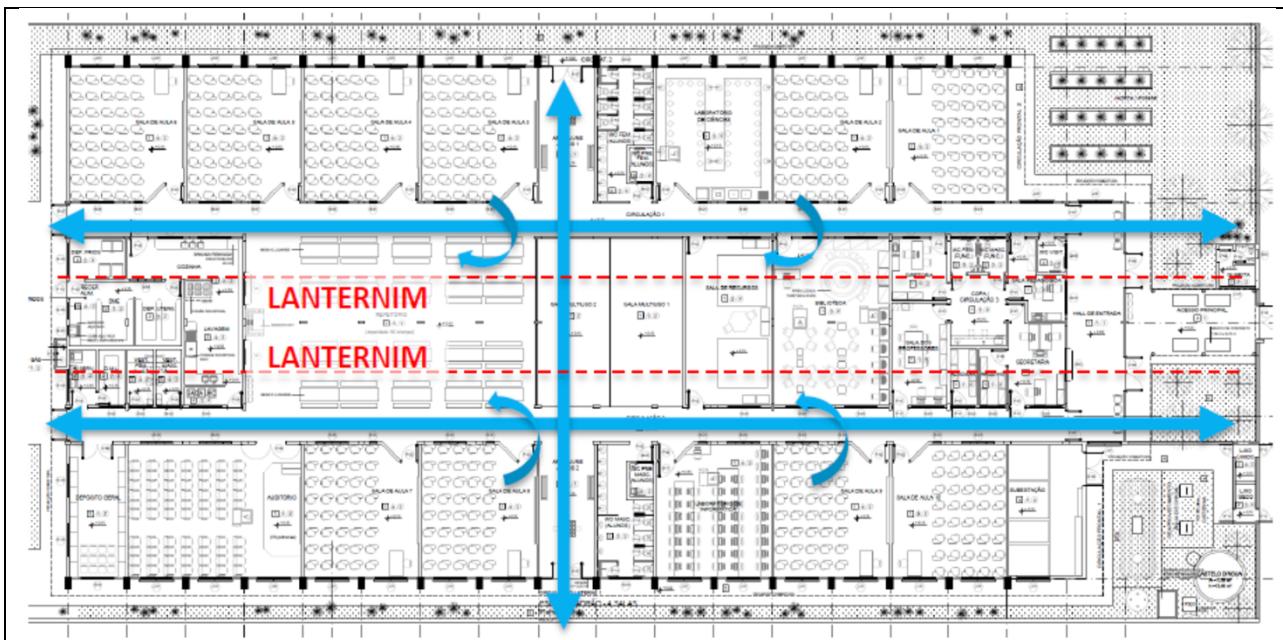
Planta tipo de um CMEI. Fonte: SMED
